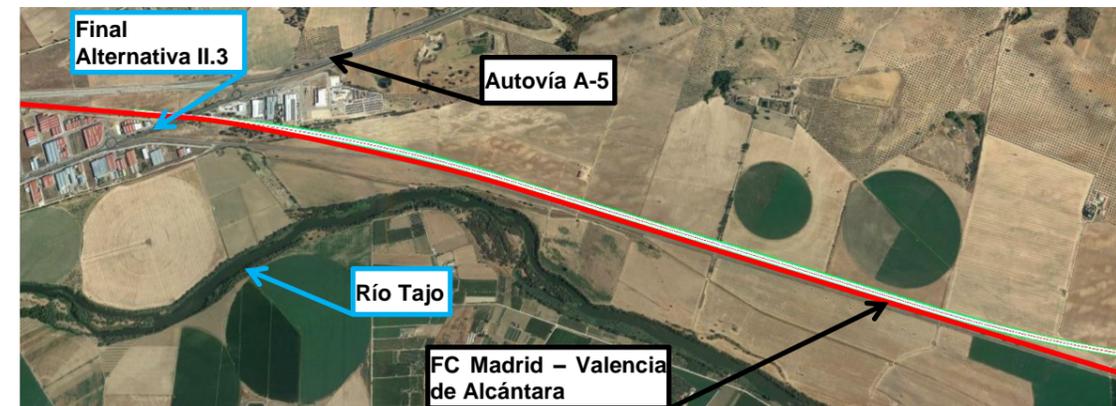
Trazado de la nueva LAV en paralelo al corredor existente.
